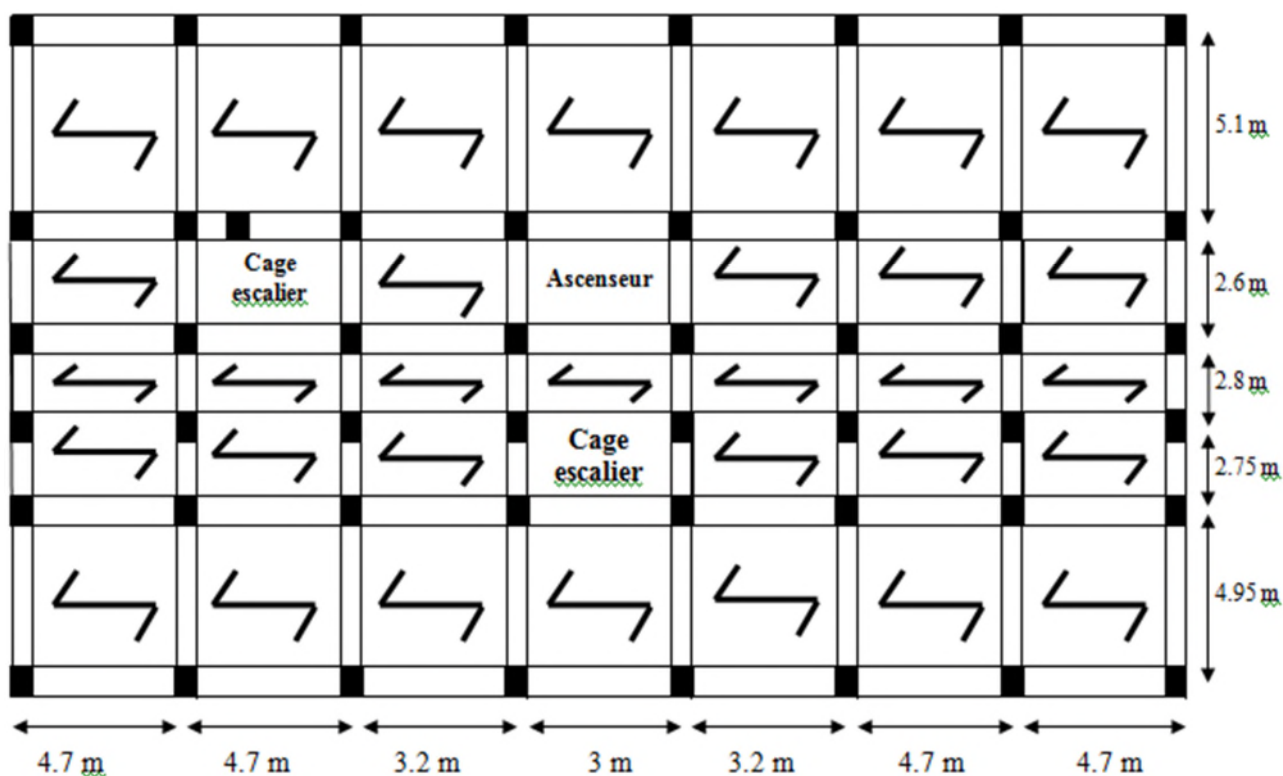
Plan de disposition des poutrelles pour les étages courants du 2^{ème} au 9^{ème}
